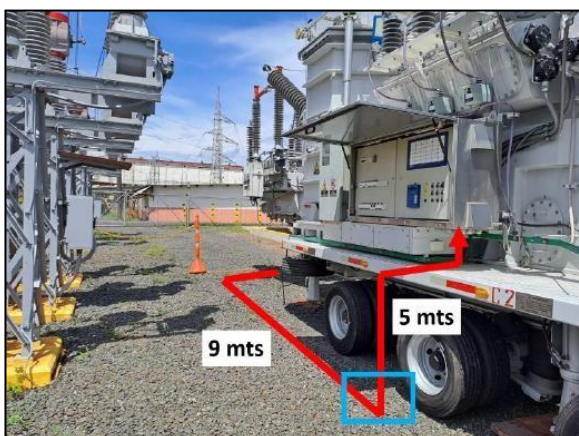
Tuberías utilizadas para la instalación de la fibra ADSS Multimodo.
